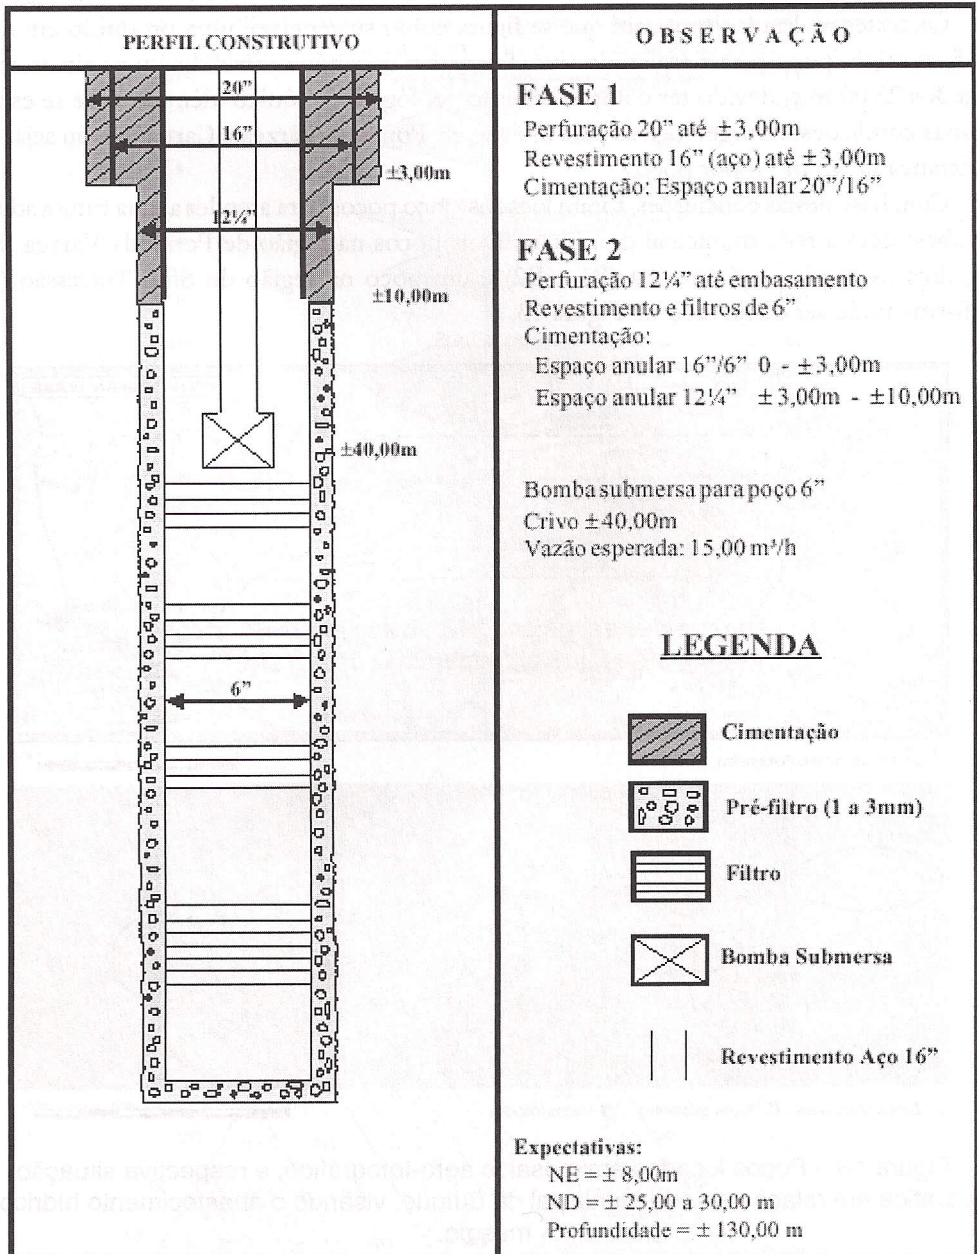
Sugestão de perfil construtivo do poço tubular.
